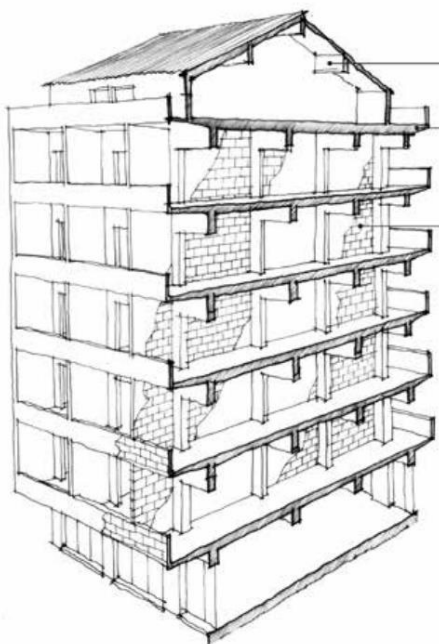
Esquema de um edifício em estrutura reticulada de betão armado, (Fonte: Secção Regional Sul da Ordem dos Arquitectos, 2016))
